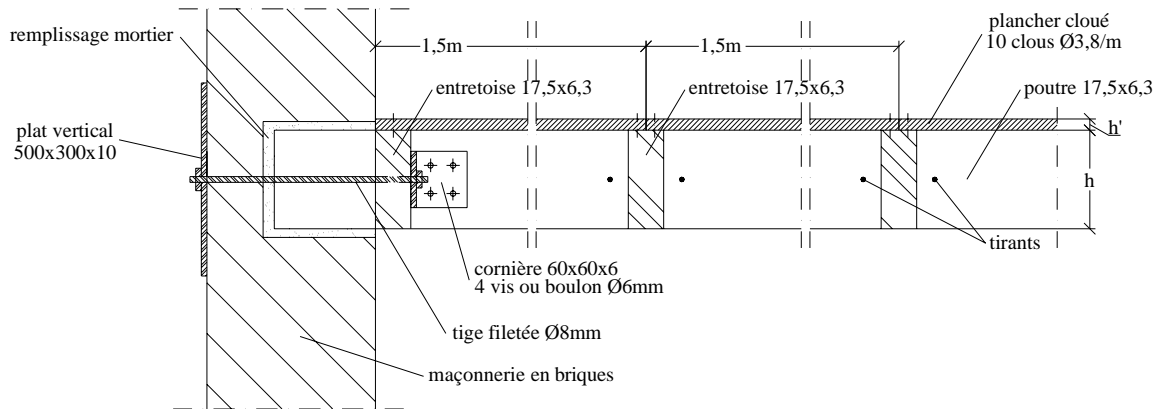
Liaison entre poutre de plancher en bois et mur avec plaque à l'arrière du mur.
